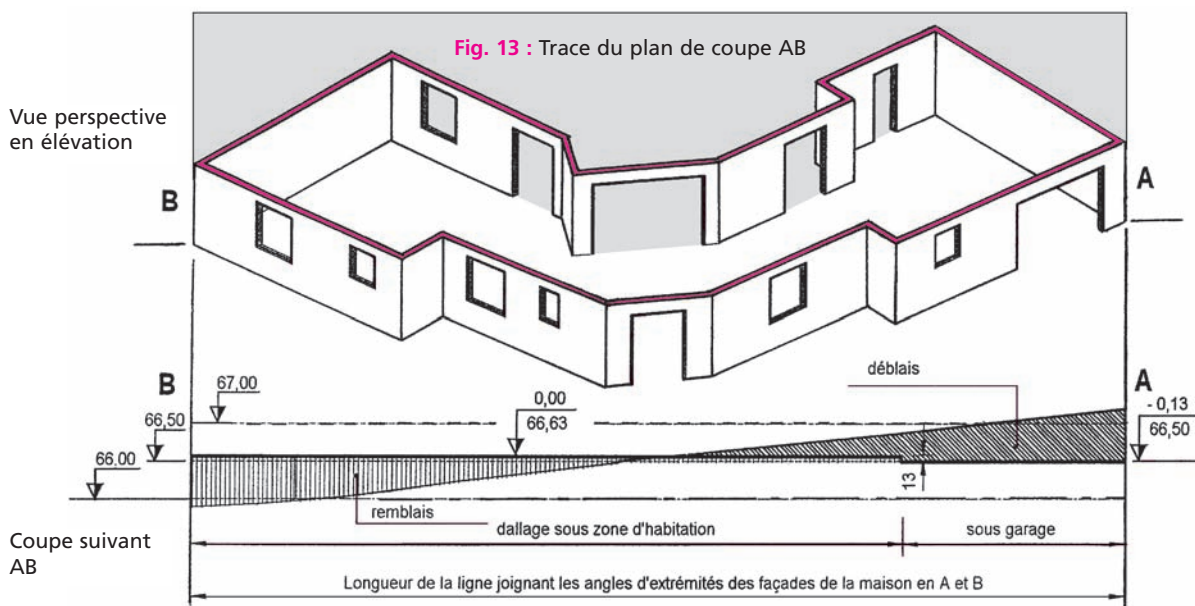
Profil des déblais et remblais dans le plan de coupe AB
